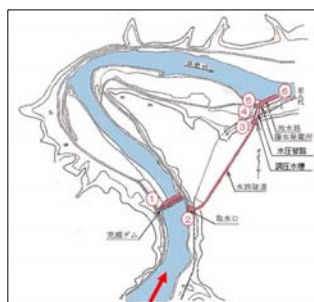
荒瀬ダム・藤本発電所施設位置図
